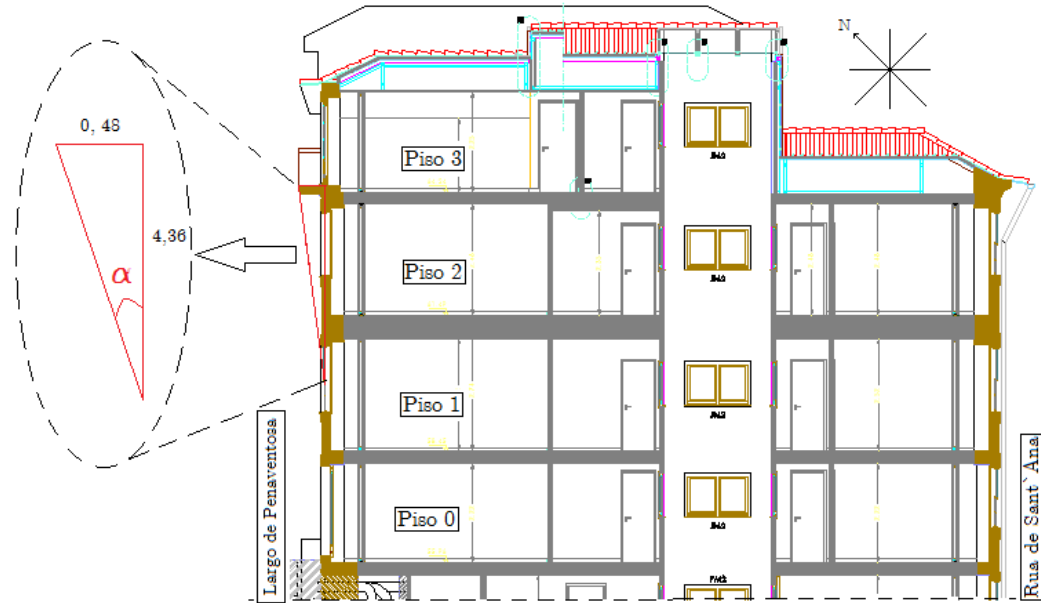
Sombreamento por elementos horizontais orientado a nordeste - Fonte: Projeto de arquitetura
